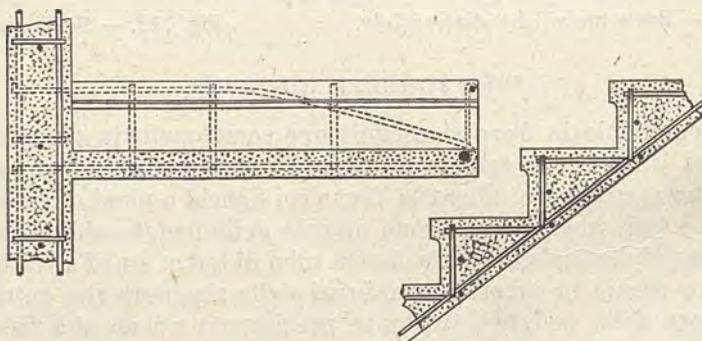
Sezione trasversale e longitudinale di una rampa di scala con scalini in cemento armato a sbalzo, incastrati in muro pure di cemento armato.
